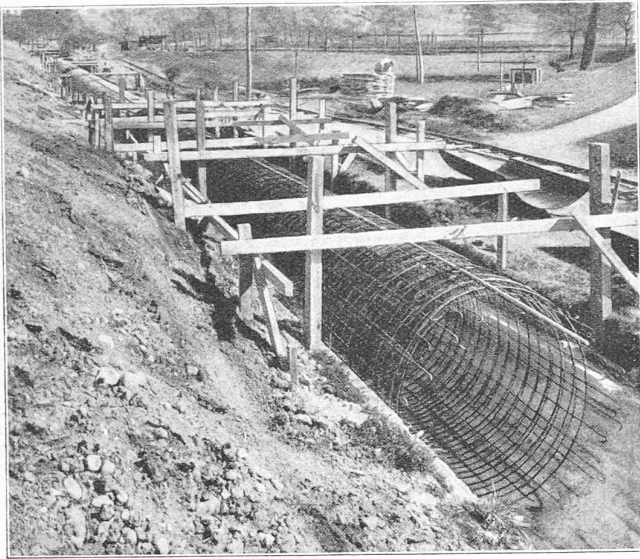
Armature de la conduite forcée. En dessous, le berceau de fondation bétonné, avant la mise en place du coffrage intérieur.
